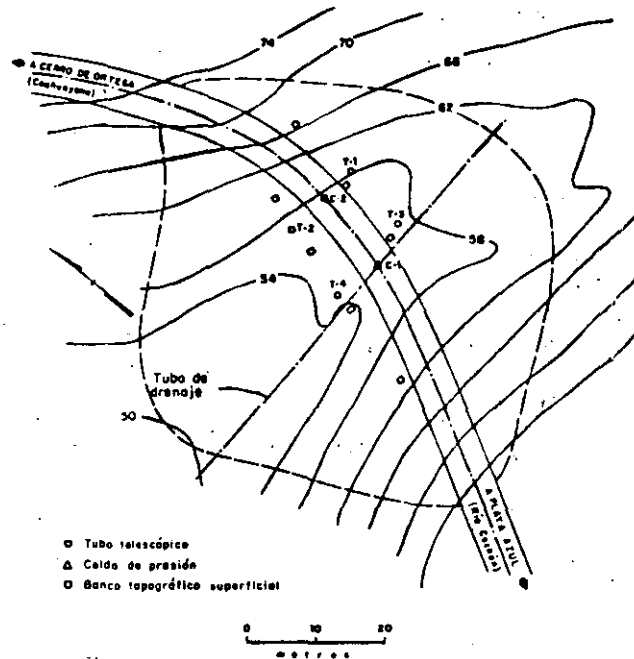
Planta de localización de la instrumentación dispuesta en el pedraplén "La Plazuela".
